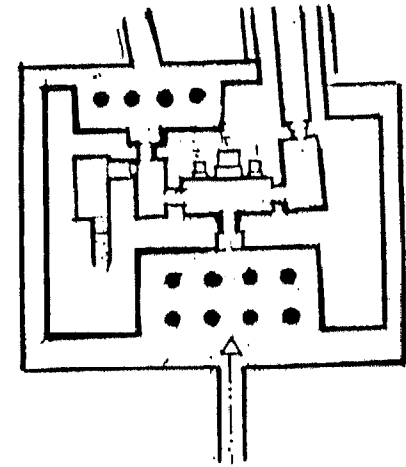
مسقط أفقي لمدخل معبد الوادي " أبي الهول "
